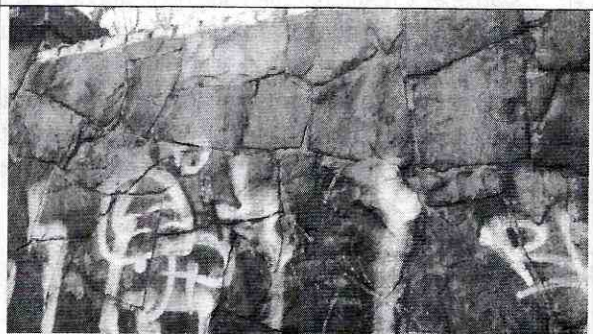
Fisura escalonada, sigue la pega entre bloques.
